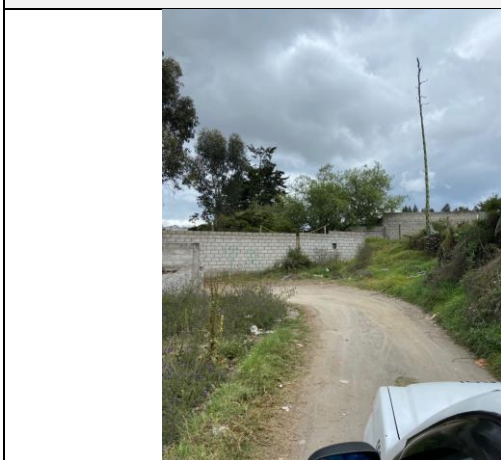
Vista tramo 2 – sin acceso por cerramiento.
